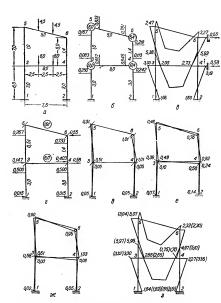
Расчет однопролетной рамы на встровую нагрузку:
